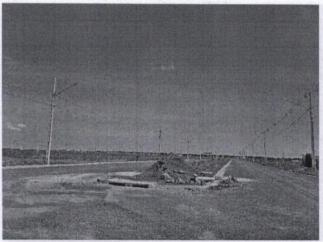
AVENIDA A - BOCAS DE LOBO EXECUTADAS.
